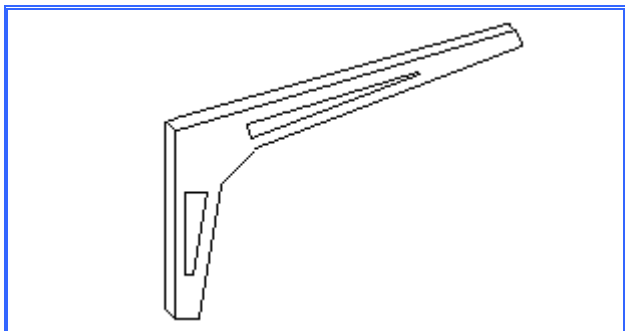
Залізобетонна рама для сільськогосподарських будівель.
